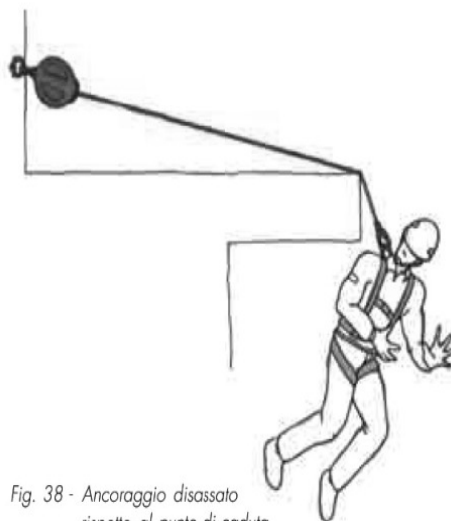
Ancoraggio disassato rispetto al punto di caduta
